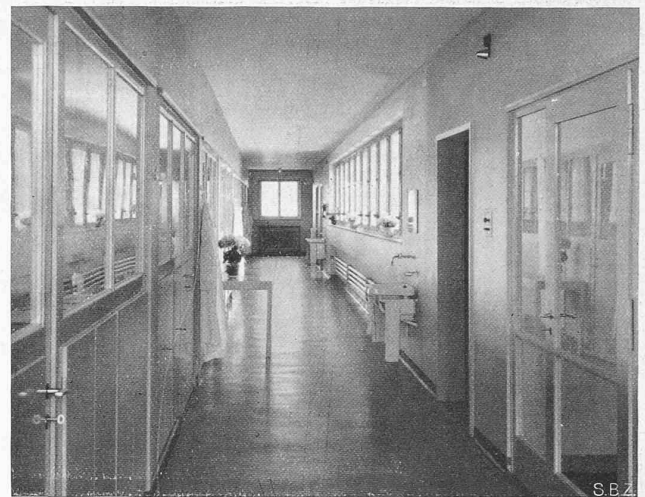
Längsgang im Isolierbau-Erdgeschoss.
